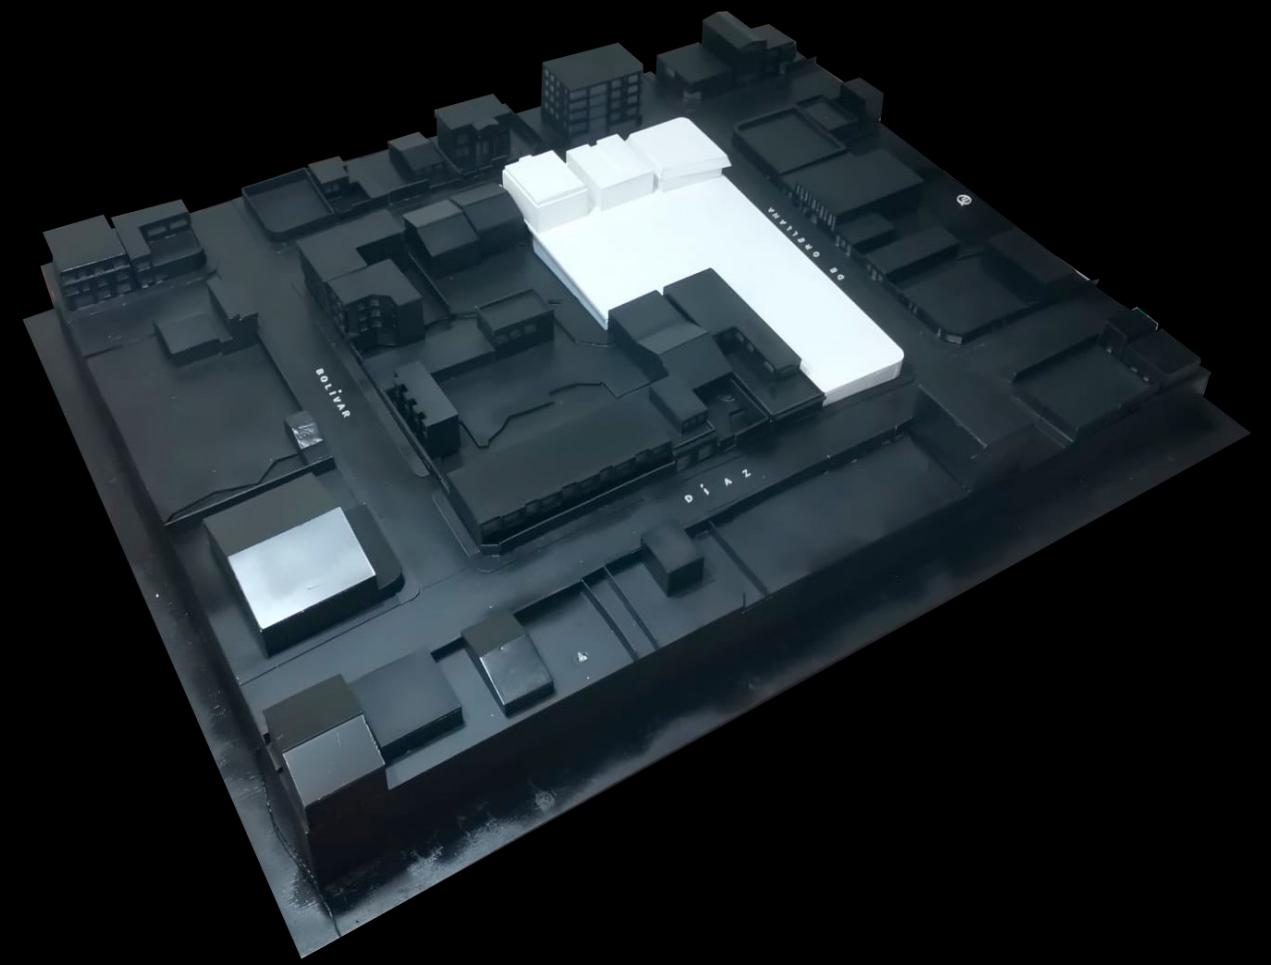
Maqueta estado actual, vista entre las calles Simón Bolívar y Gonzalo Díaz
